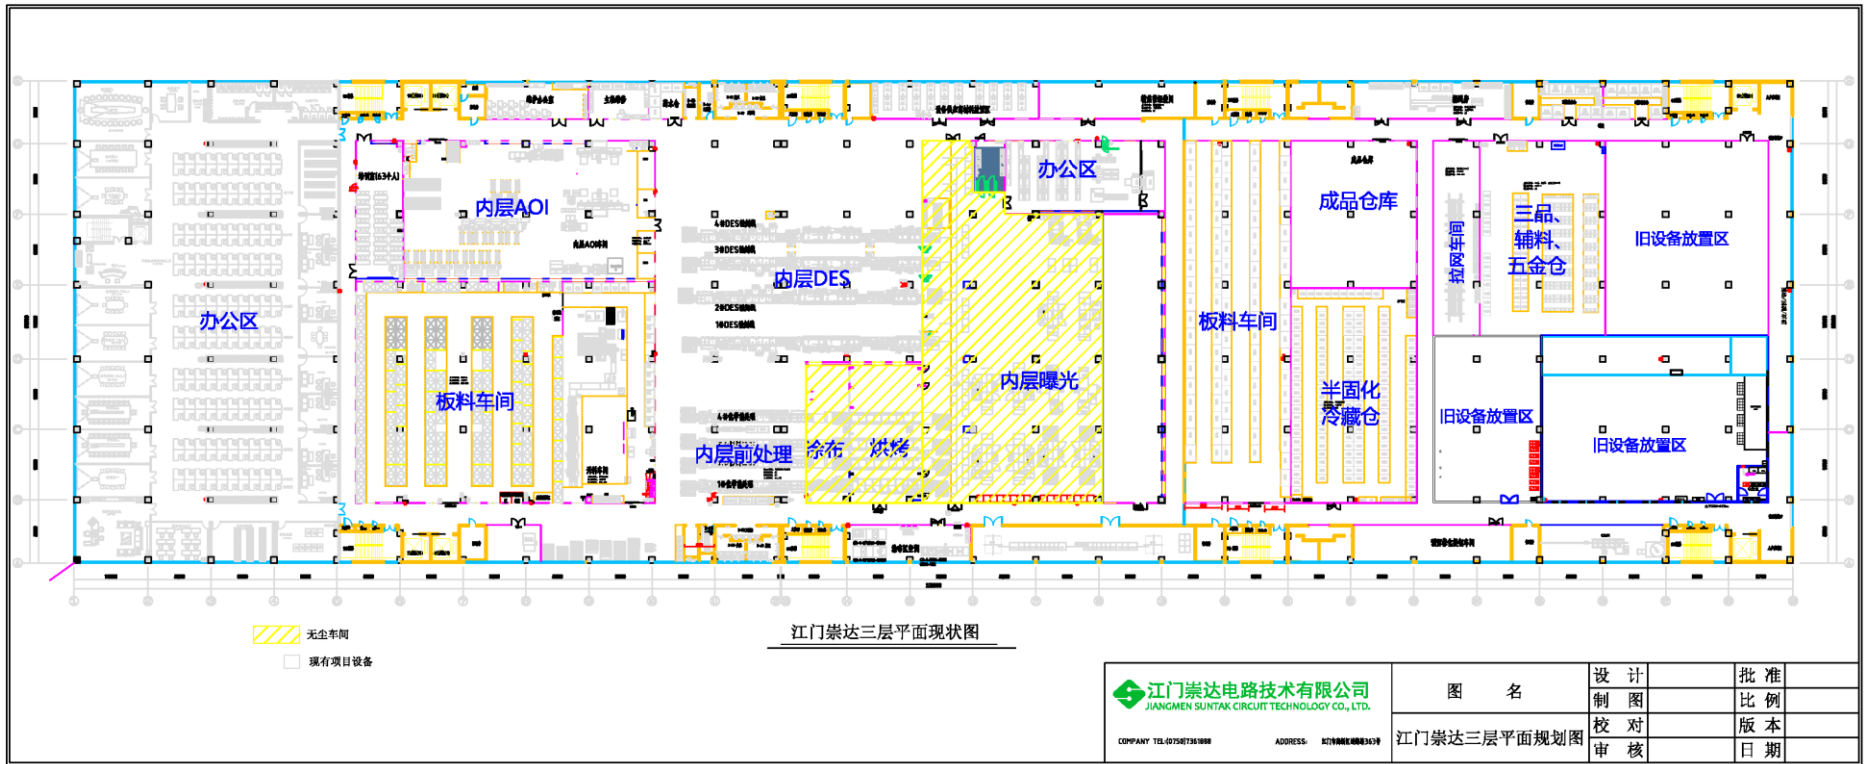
(c) 现有项目厂房一 3F 车间平面布置图
